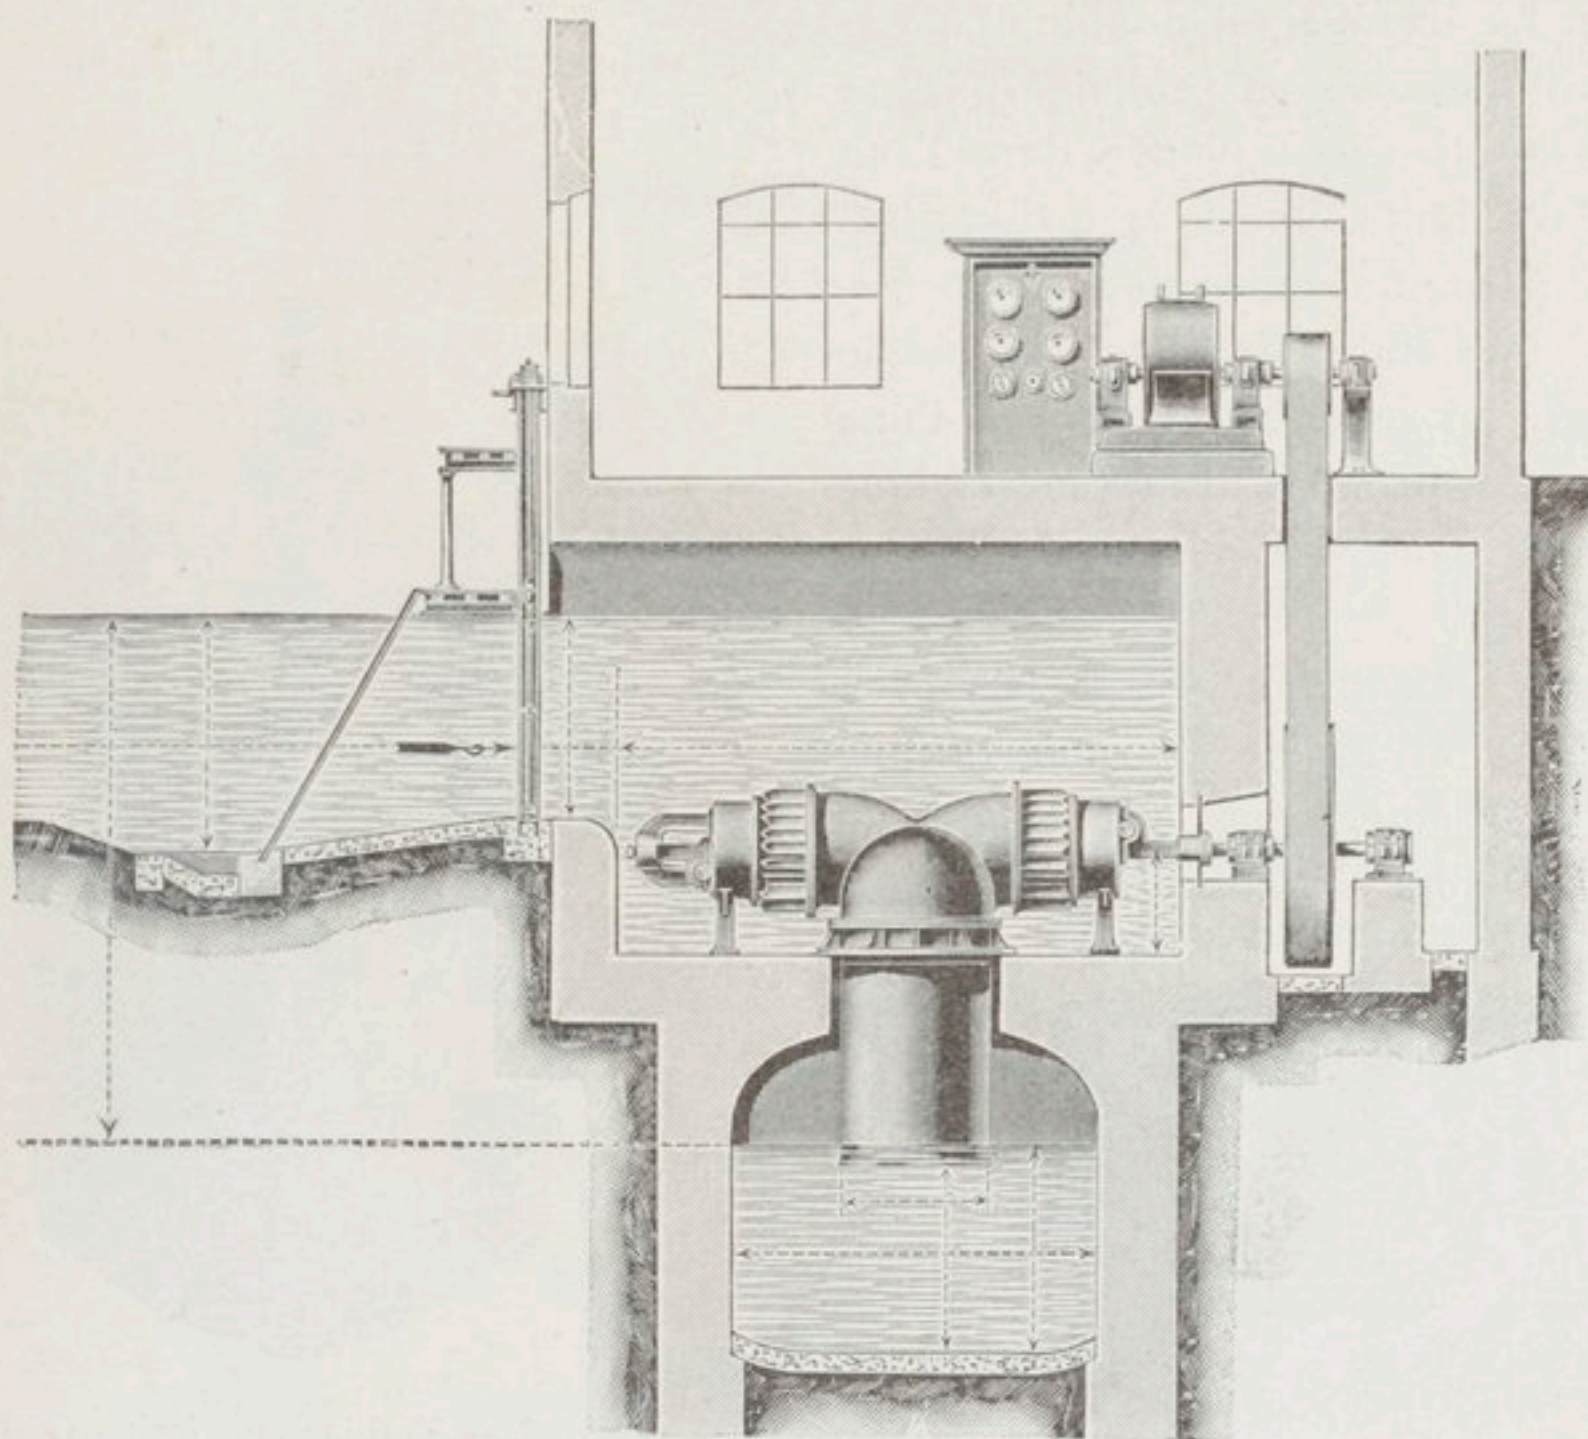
Turbine Hercule-Progrès jumelle à axe horizontal.
